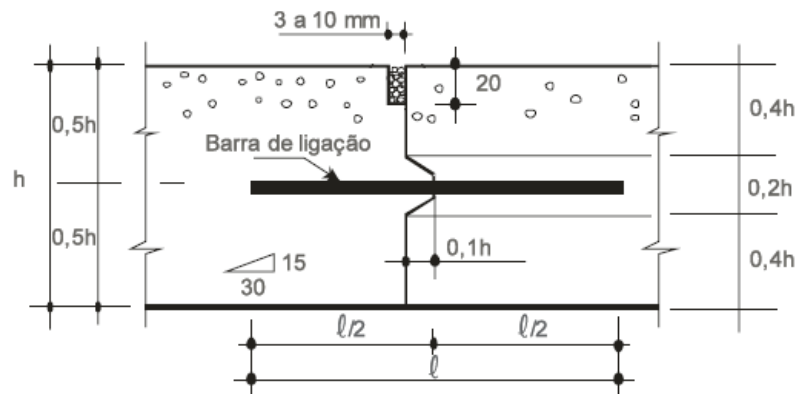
Exemplo de junta longitudinal com barra de ligação tipo encaixe “macho-e-fêmea”. (Fonte: Manual de Pavimentação DNIT, 2004)
